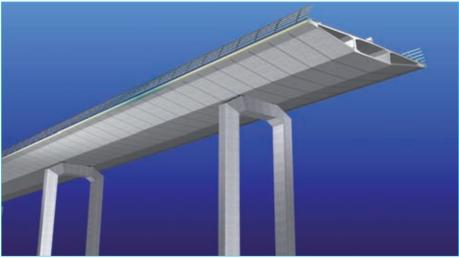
Detalle de las pilas. Segundo subtramo del Tramo Viaducto de acceso a Puerto Rreal. Puente sobre la Bahía
